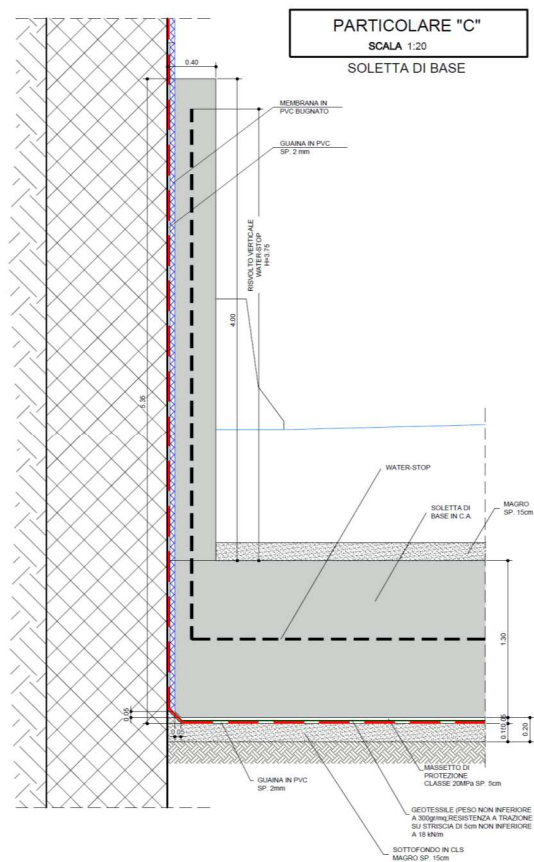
Particolare impermeabilizzazione solettone di fondo (sezione fra diaframmi)
